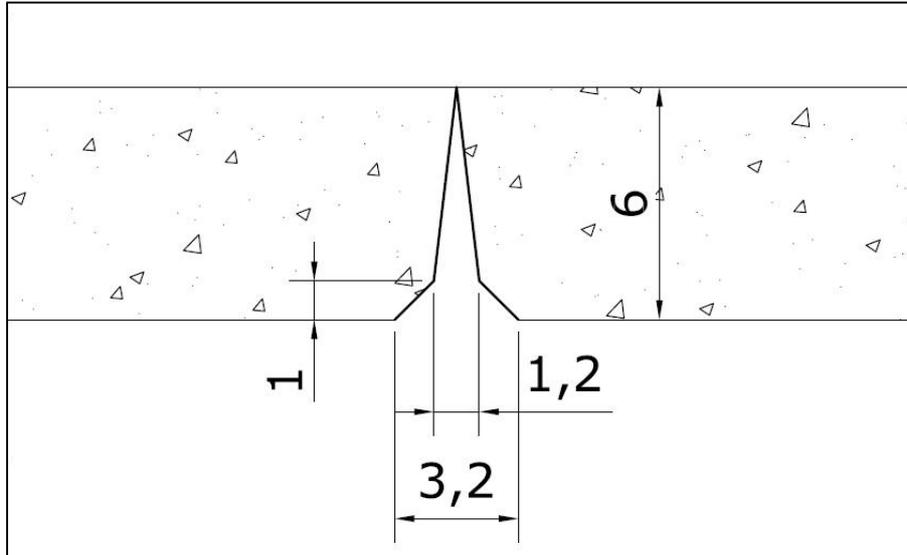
DETALLE DE UNIÓN CON ZAPATA EXTREMA
